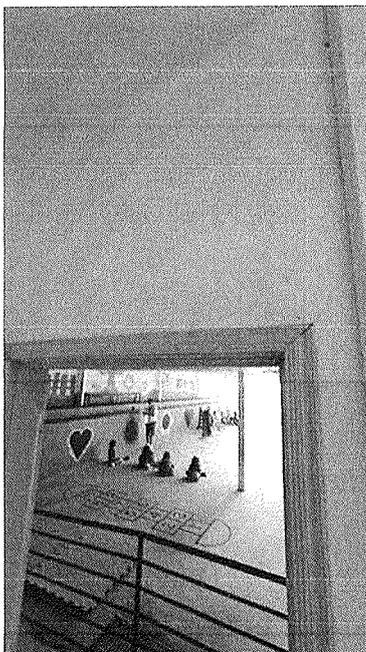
Infiltração na parede superior da porta de acesso ao pátio, área interna
